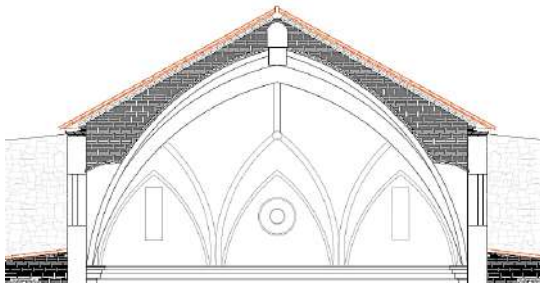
Detalle de la bóveda de crucería en sección. Imagen propia 20/08/17
